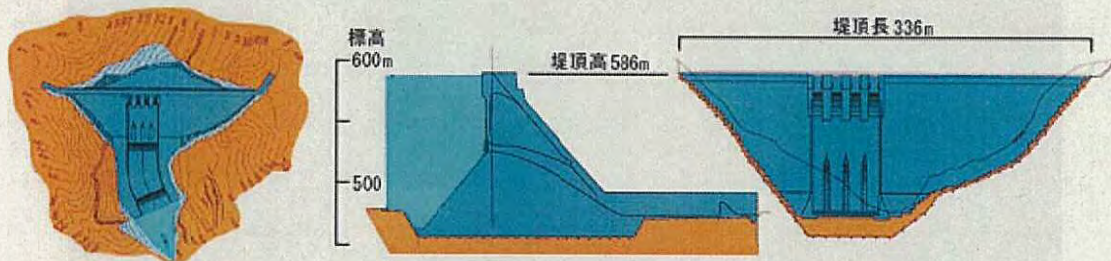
ハッ場ダムの平面図・標準断面図・下流面図 (出典:ハッ場ダム工事事務所HP)
